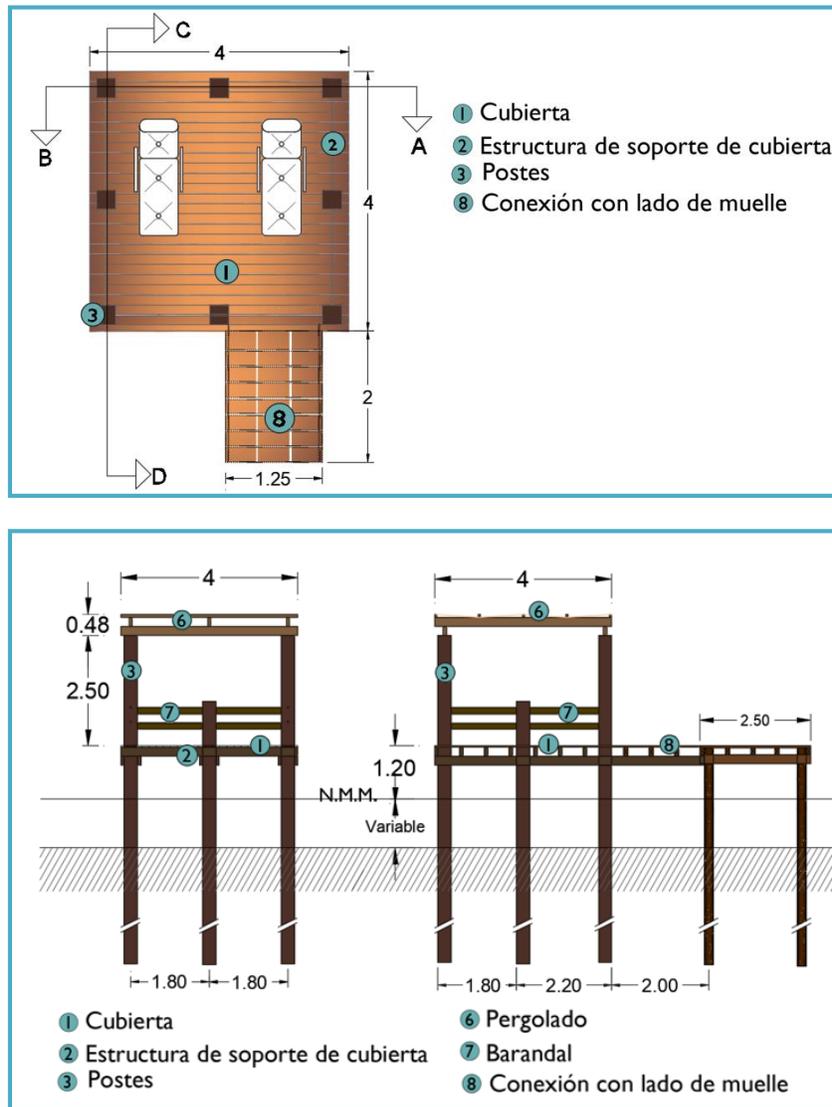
Vista de planta y cortes trasversal y longitudinal de los gazebos.
